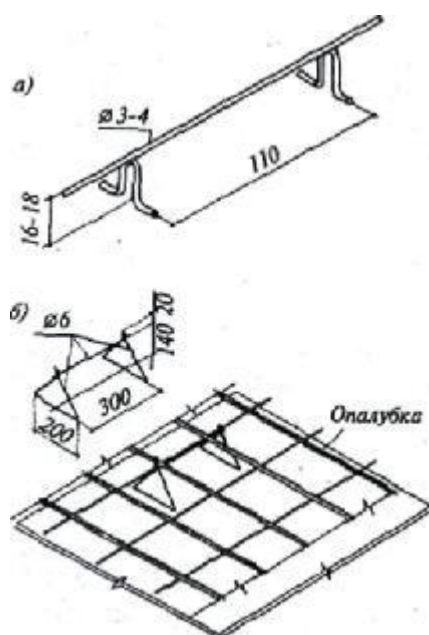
«Лягушка» и «козелок» для обеспечения защитного слоя бетона в перекрытиях:
